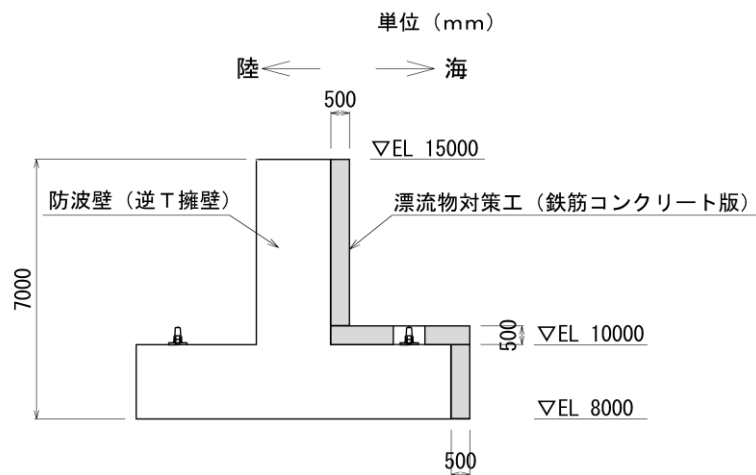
(3) 漂流物対策工 (鉄筋コンクリート版) の構造概要図 (標準断面図)
